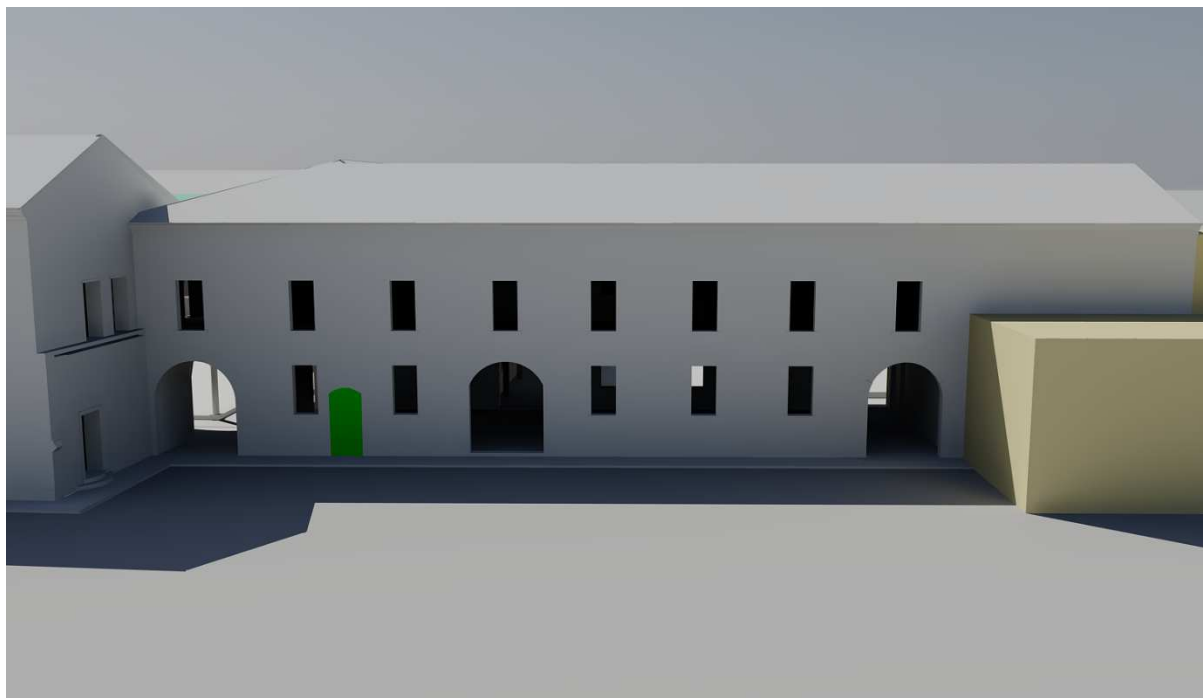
Vista della porzione destra del prospetto Ovest.
